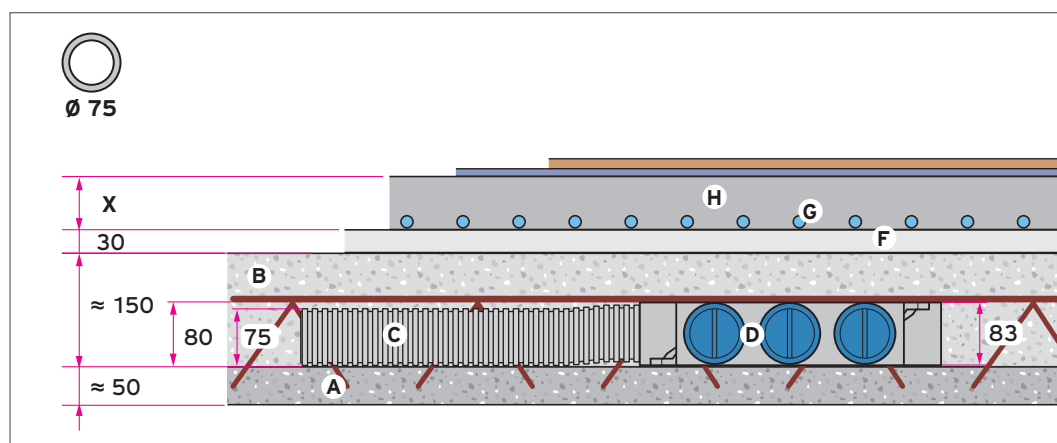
Fußbodenaufbau bei Verlegung von Rundrohren im Rohbeton
